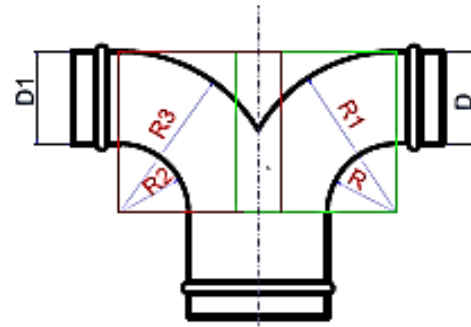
مسقط لشبكة مجرى هواء دائري المقطع
